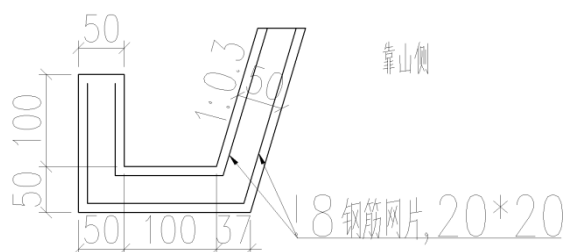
巴东隧道进口渣场截水沟剖面图
